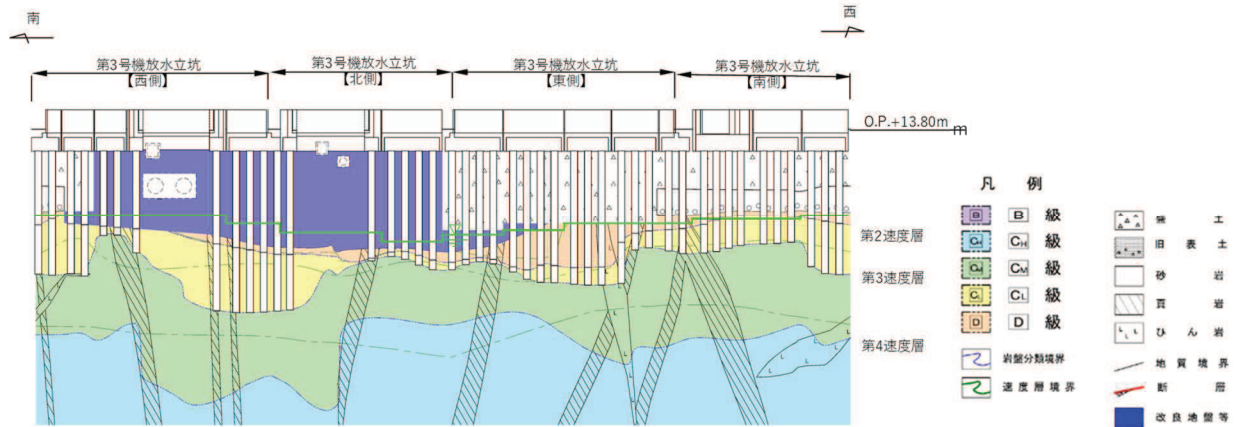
地盤改良体の配置図 (防潮壁 (第 3 号機放水立坑) , K-K 断面)
